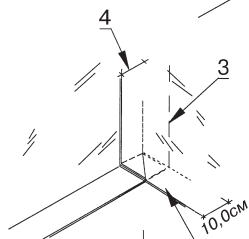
Гидроизоляция трубы диаметром более 300 мм
